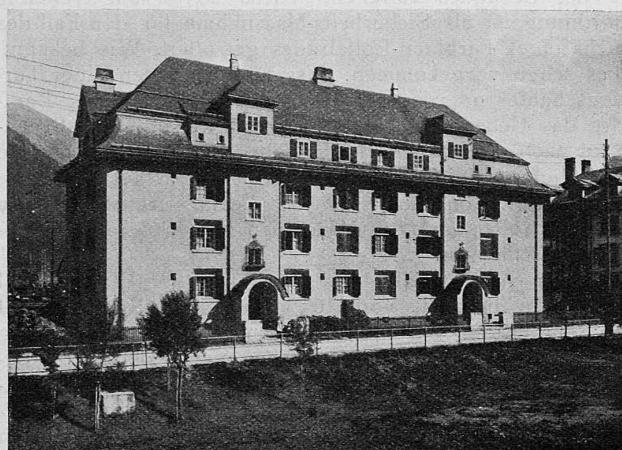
Strassenfront (N-W) eines Wohnhauses für 4×3 Familien der Rhät. Bahn in Samaden. — Abb. 2. Grundrisse dazu, 1:400.
